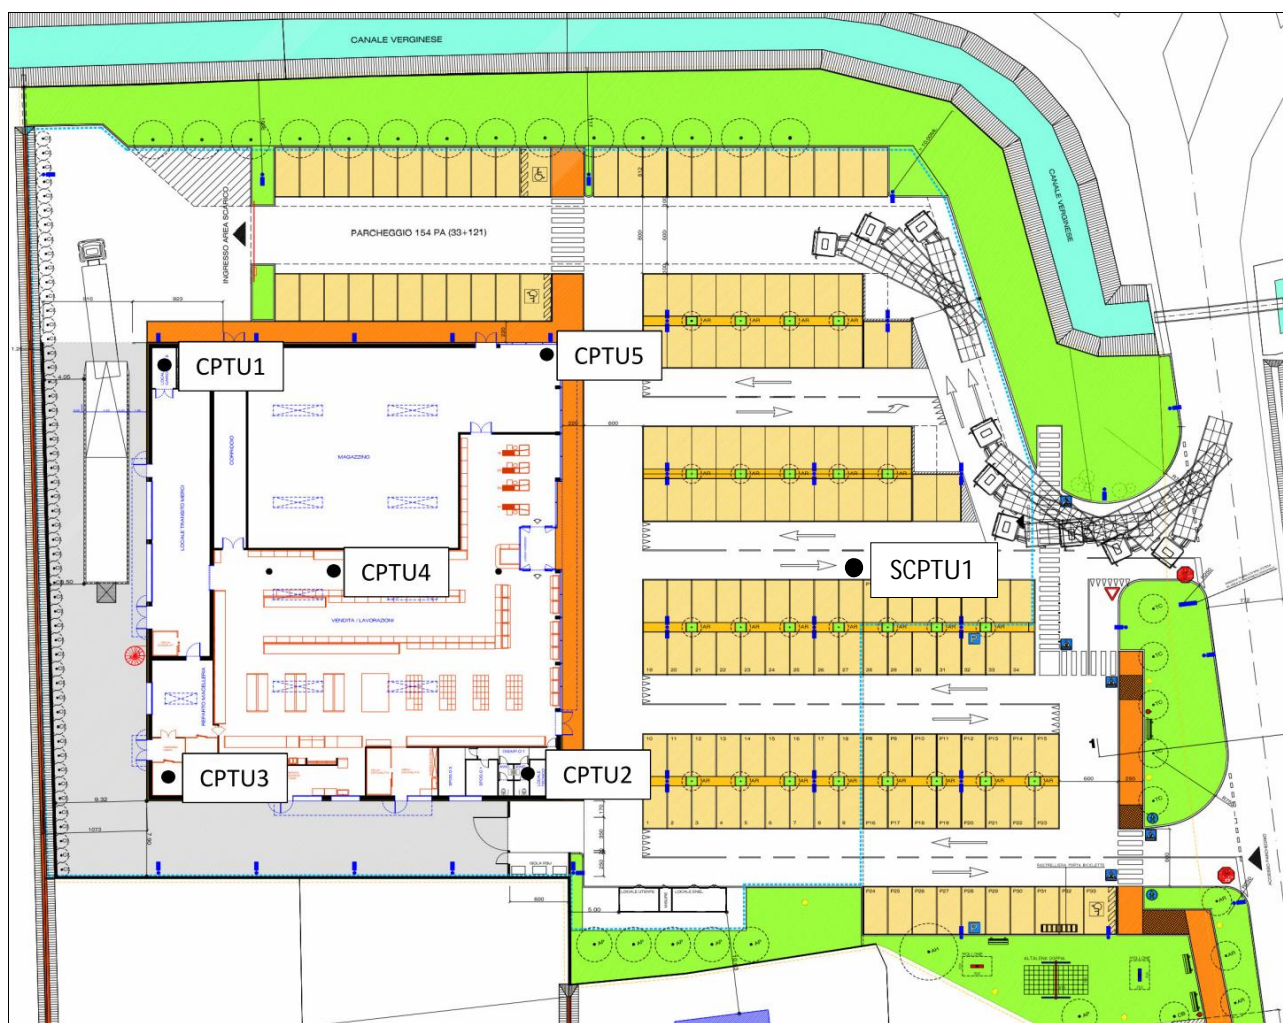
Planimetria generale con ubicazione indagini
